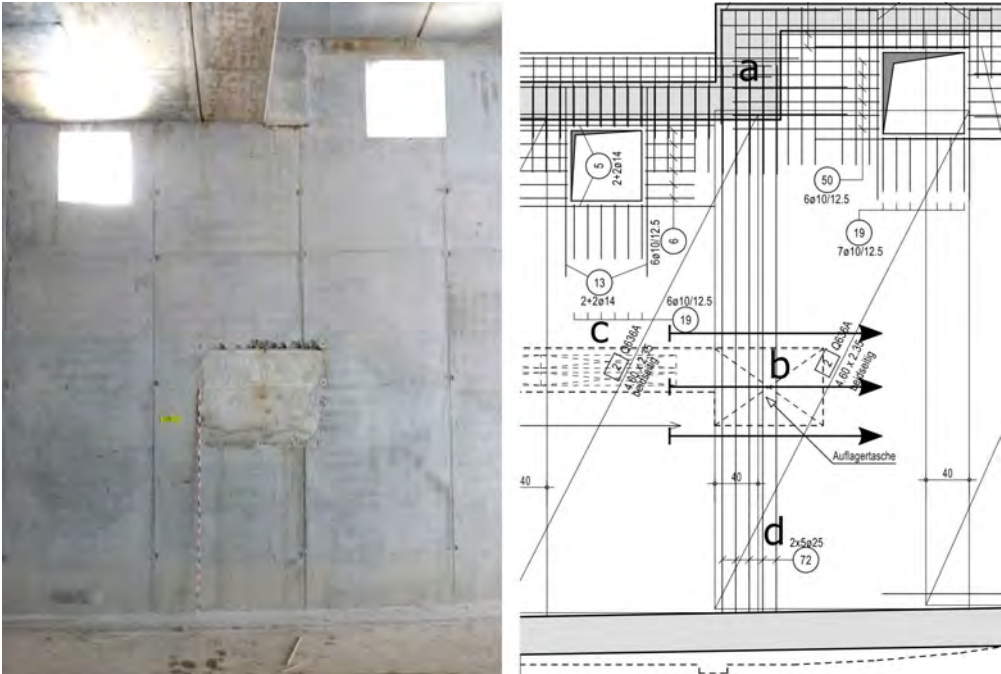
Wandansicht und zugehöriger Bewehrungsplan; darin sind (a) der Unterzug, (b) Auflagertasche, (c) Grundbewehrung aus Matten Q 636 Ø 9–10 mm und (d) Zulagebewehrung $2 \times 5 \text{ } \varnothing 25 \text{ mm}$, die Pfeile kennzeichnen die Lage der Ultraschall- und Radarmessspuren
